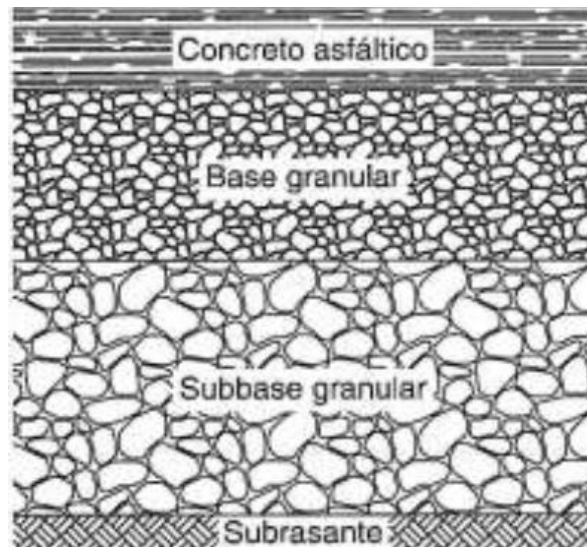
Estructura Típica de Pavimento Flexible. Fuente: (David & Paull, 1998)
